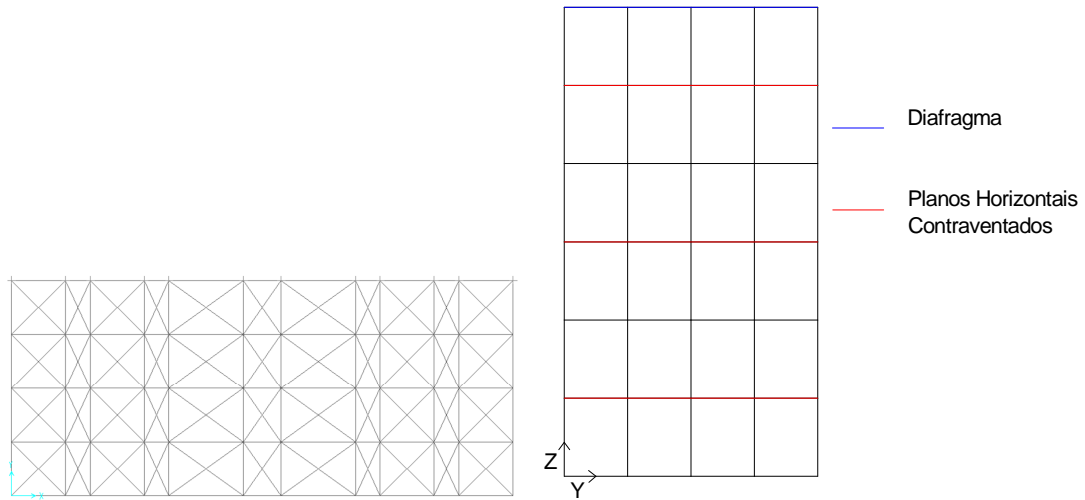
Configuração dos Planos de Contraventamento Horizontal Com Elementos de Contraventamento Pequenos
